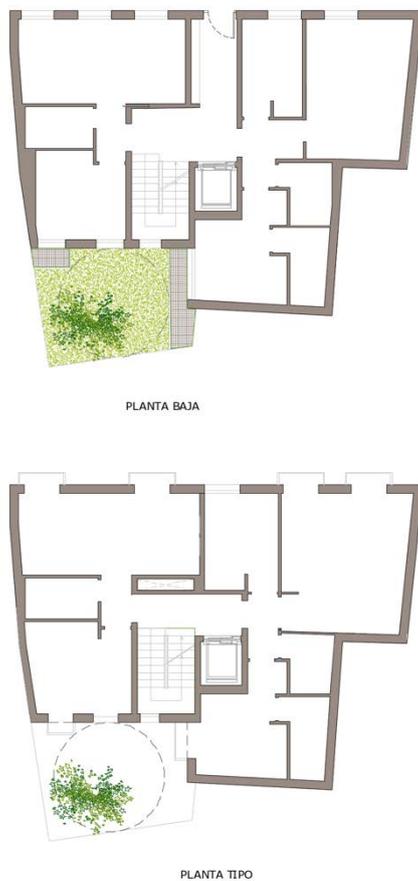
(izquierda). Planta baja y planta tipo del nuevo inmueble propuesto.
